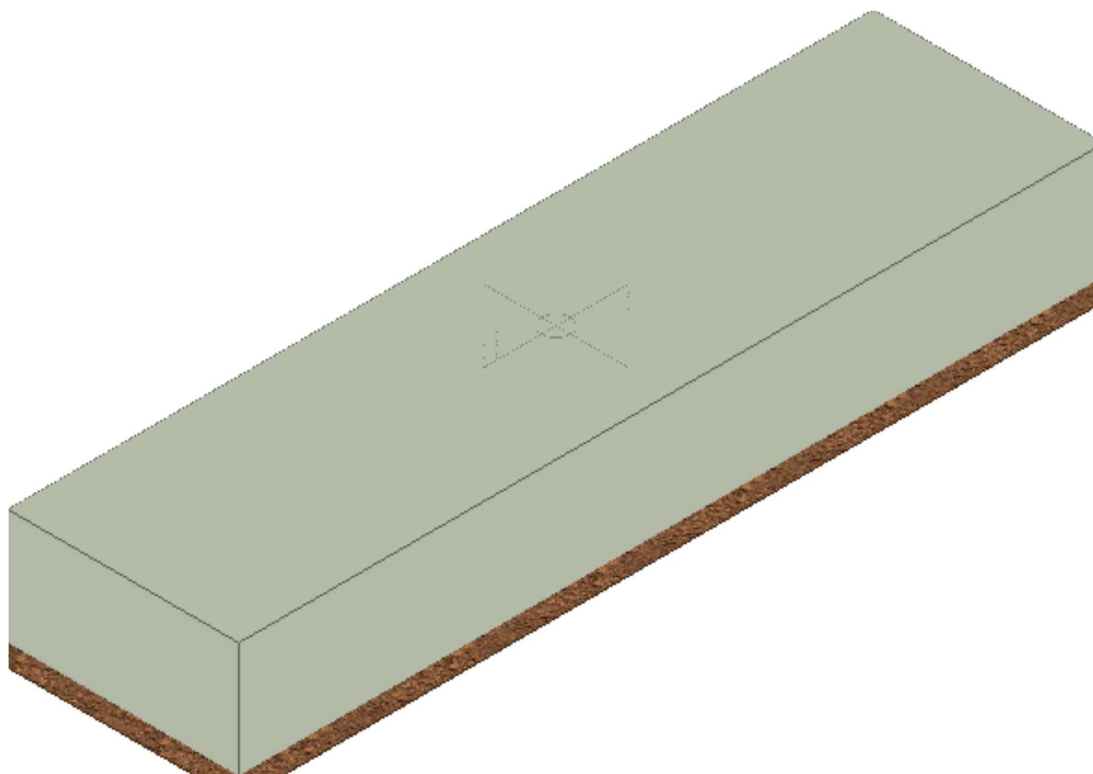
vista tridimensionale della fondazione dell'INTERRUTTORE TRIPOLARE
